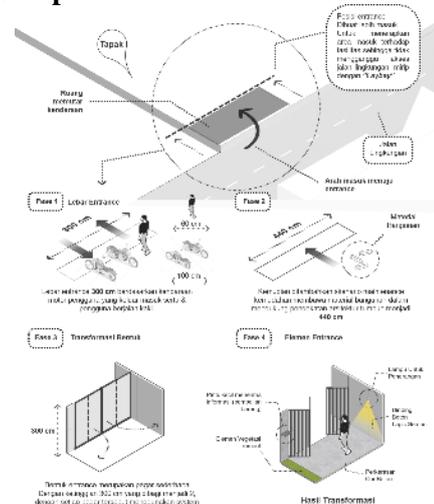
Analisa Site (Sumber: Ariyuda, 2021)
